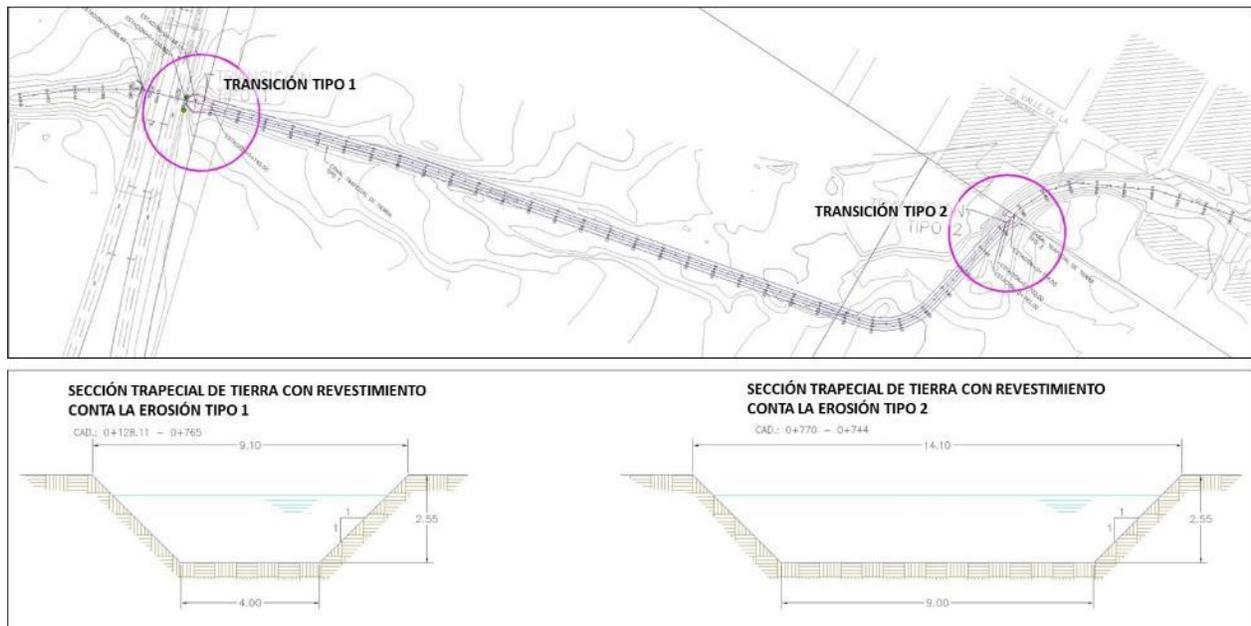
Planta del encauzamiento del Arroyo El Cuervo y sus cortes de canal.
